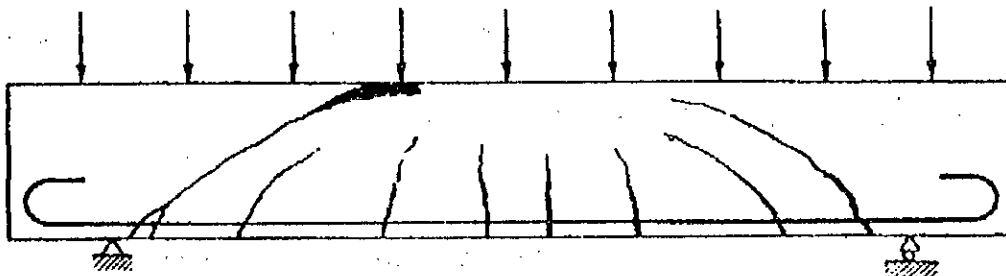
Fissuration lors de la rupture par cisaillement et flexion.
